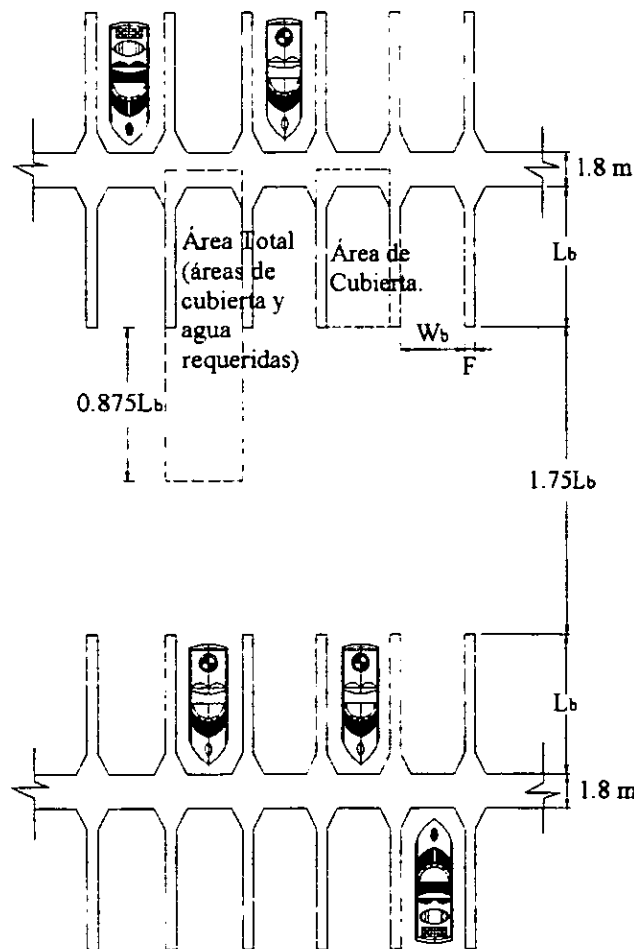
Anchuras recomendadas para ambos tipos de amarraderos.
